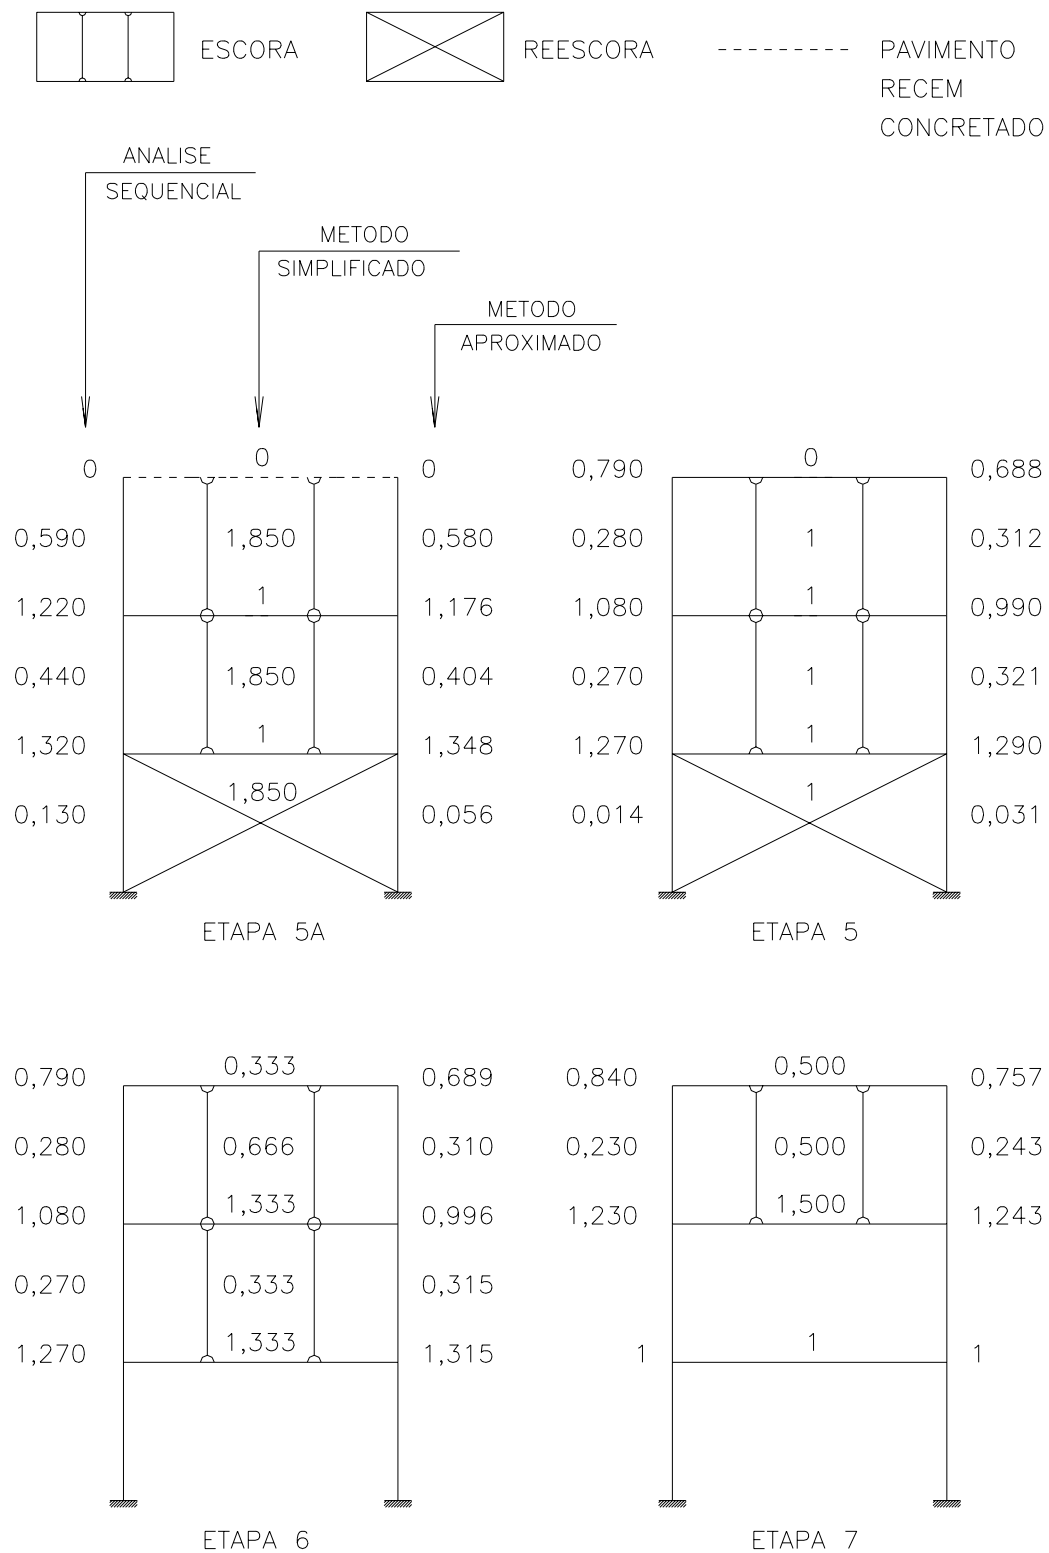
Distribuição das ações de construção segundo fatores de carga k ($x G$)
